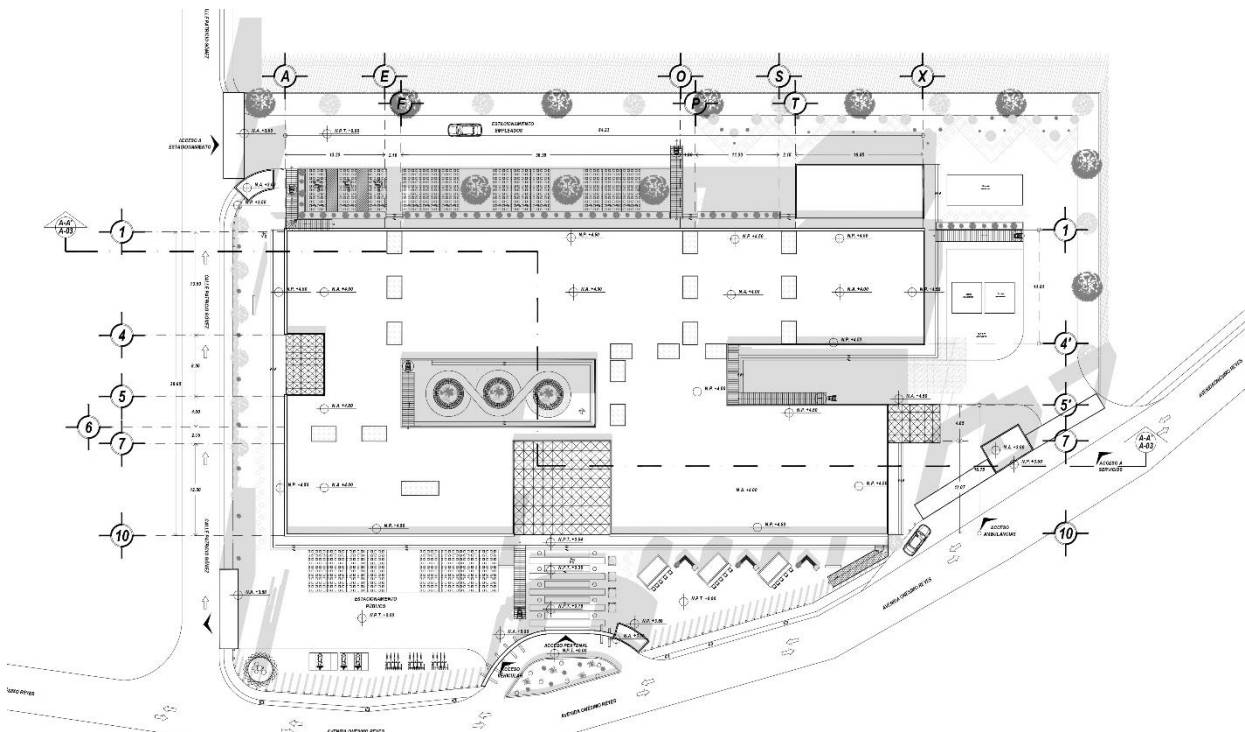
Planta de techos del conjunto (Loretto, 2021).
